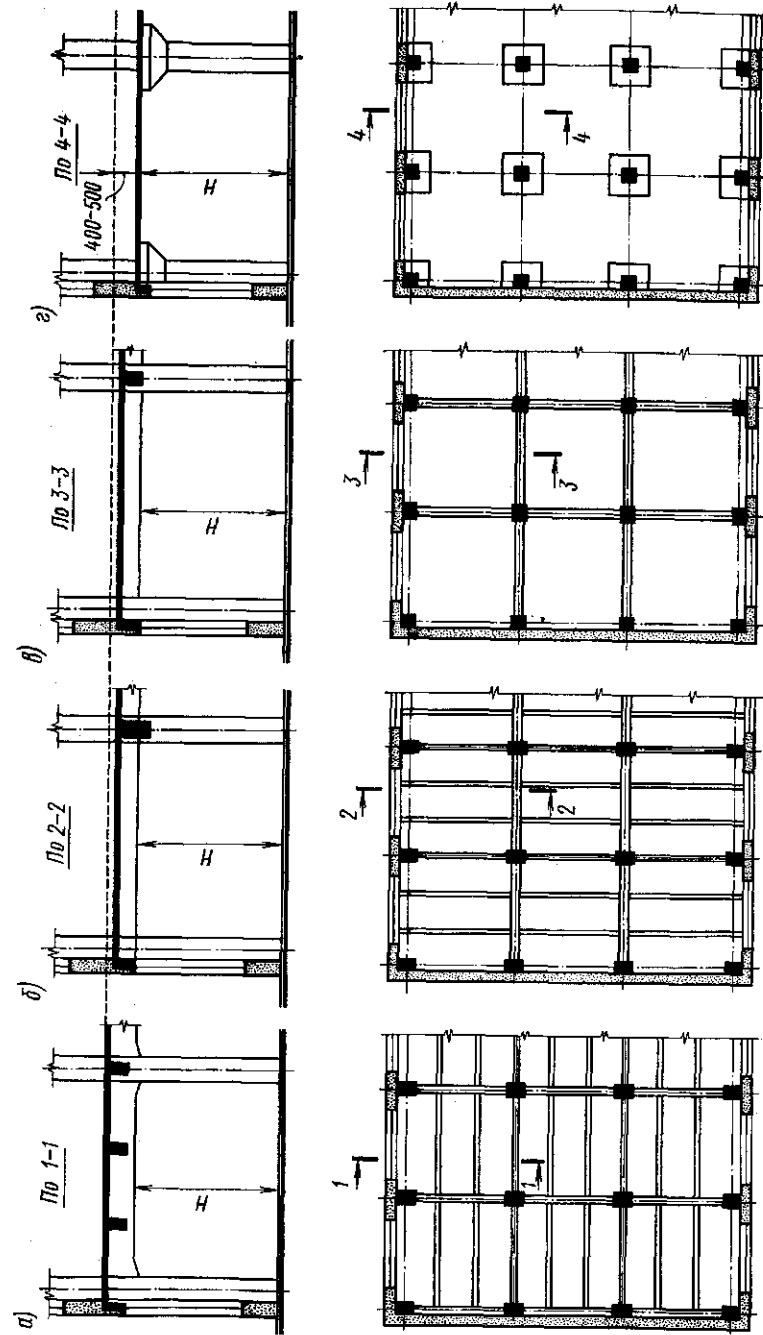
Схемы монолитных железобетонных каркасов:
